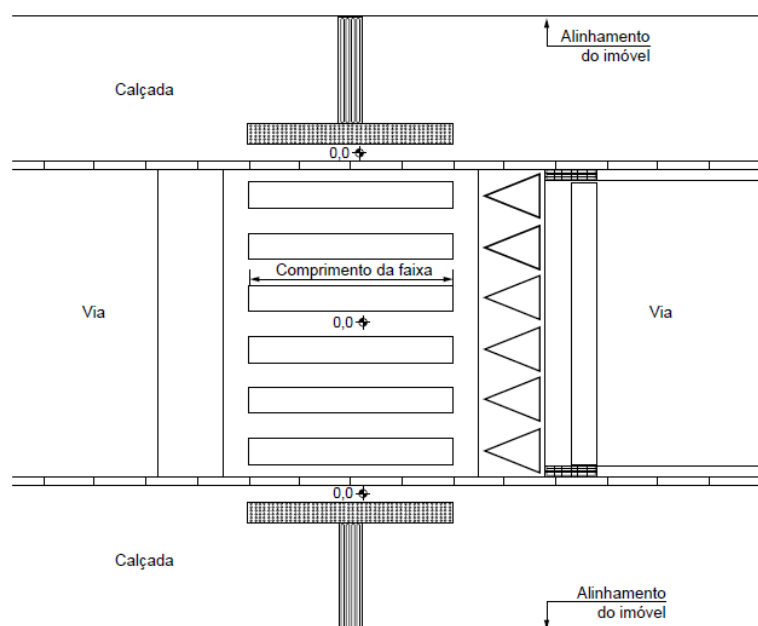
Faixa elevada para travessia - Exemplo - Vista superior.
